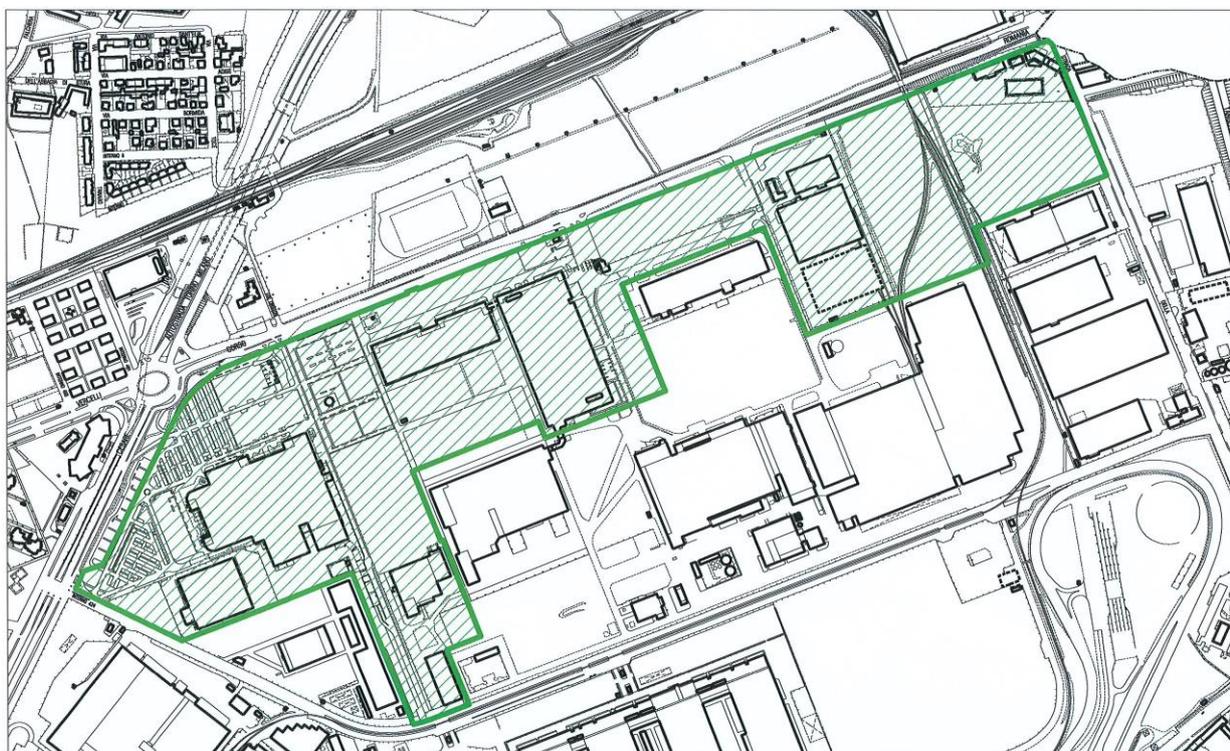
Planimetria complessiva Localizzazione Commerciale L2 Romania
